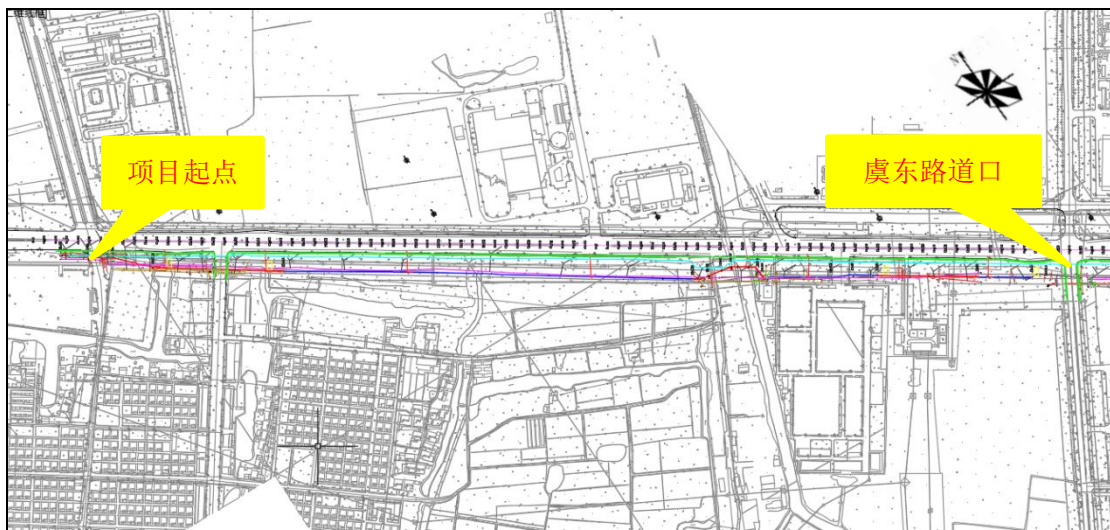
工程总平面布置图一（自西向东起点~虞东路道口）
